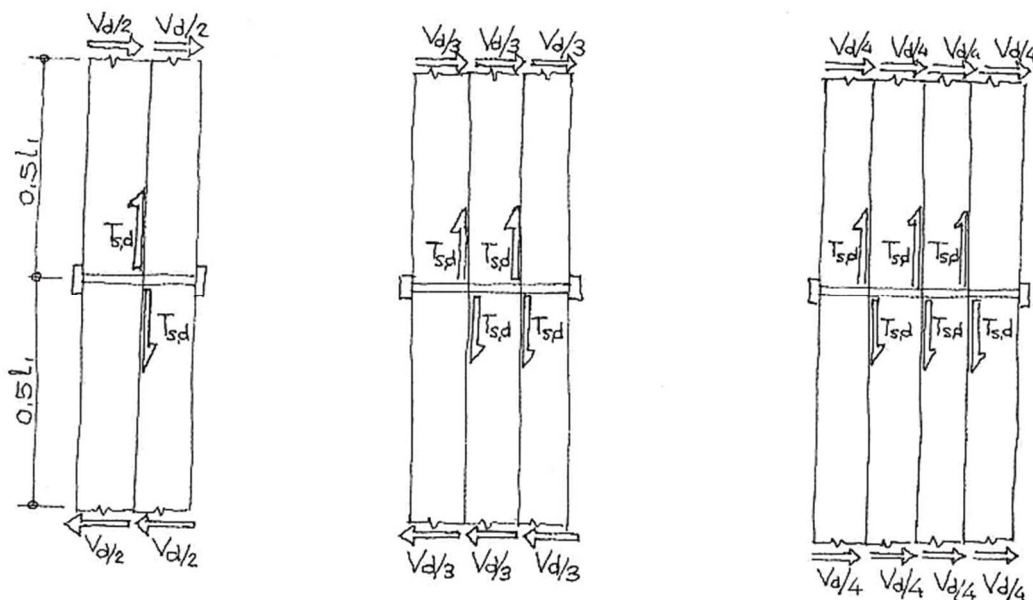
Distribución de esfuerzos en elementos unidos mediante bridas metálicas
